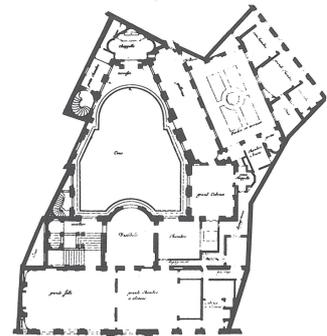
Hotel de Beauvais (1657), Antoine Le Pautre, planta
